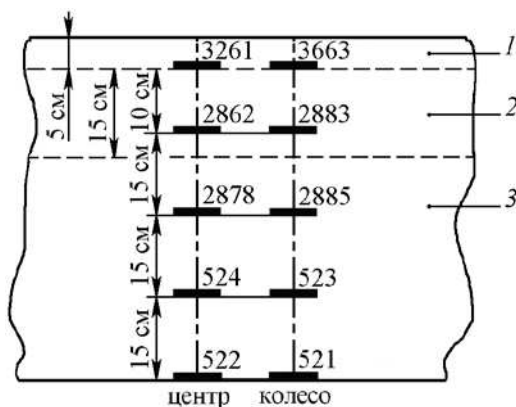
Схема закладки мессдоз, поперечный разрез: 1, 2, 3 – соответственно верхний, армированный и нижний слои грунта
